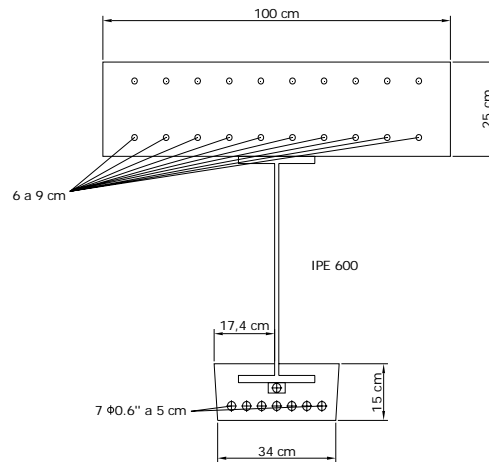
Sección mixta pretensada en taller con losa de compresión *in situ
